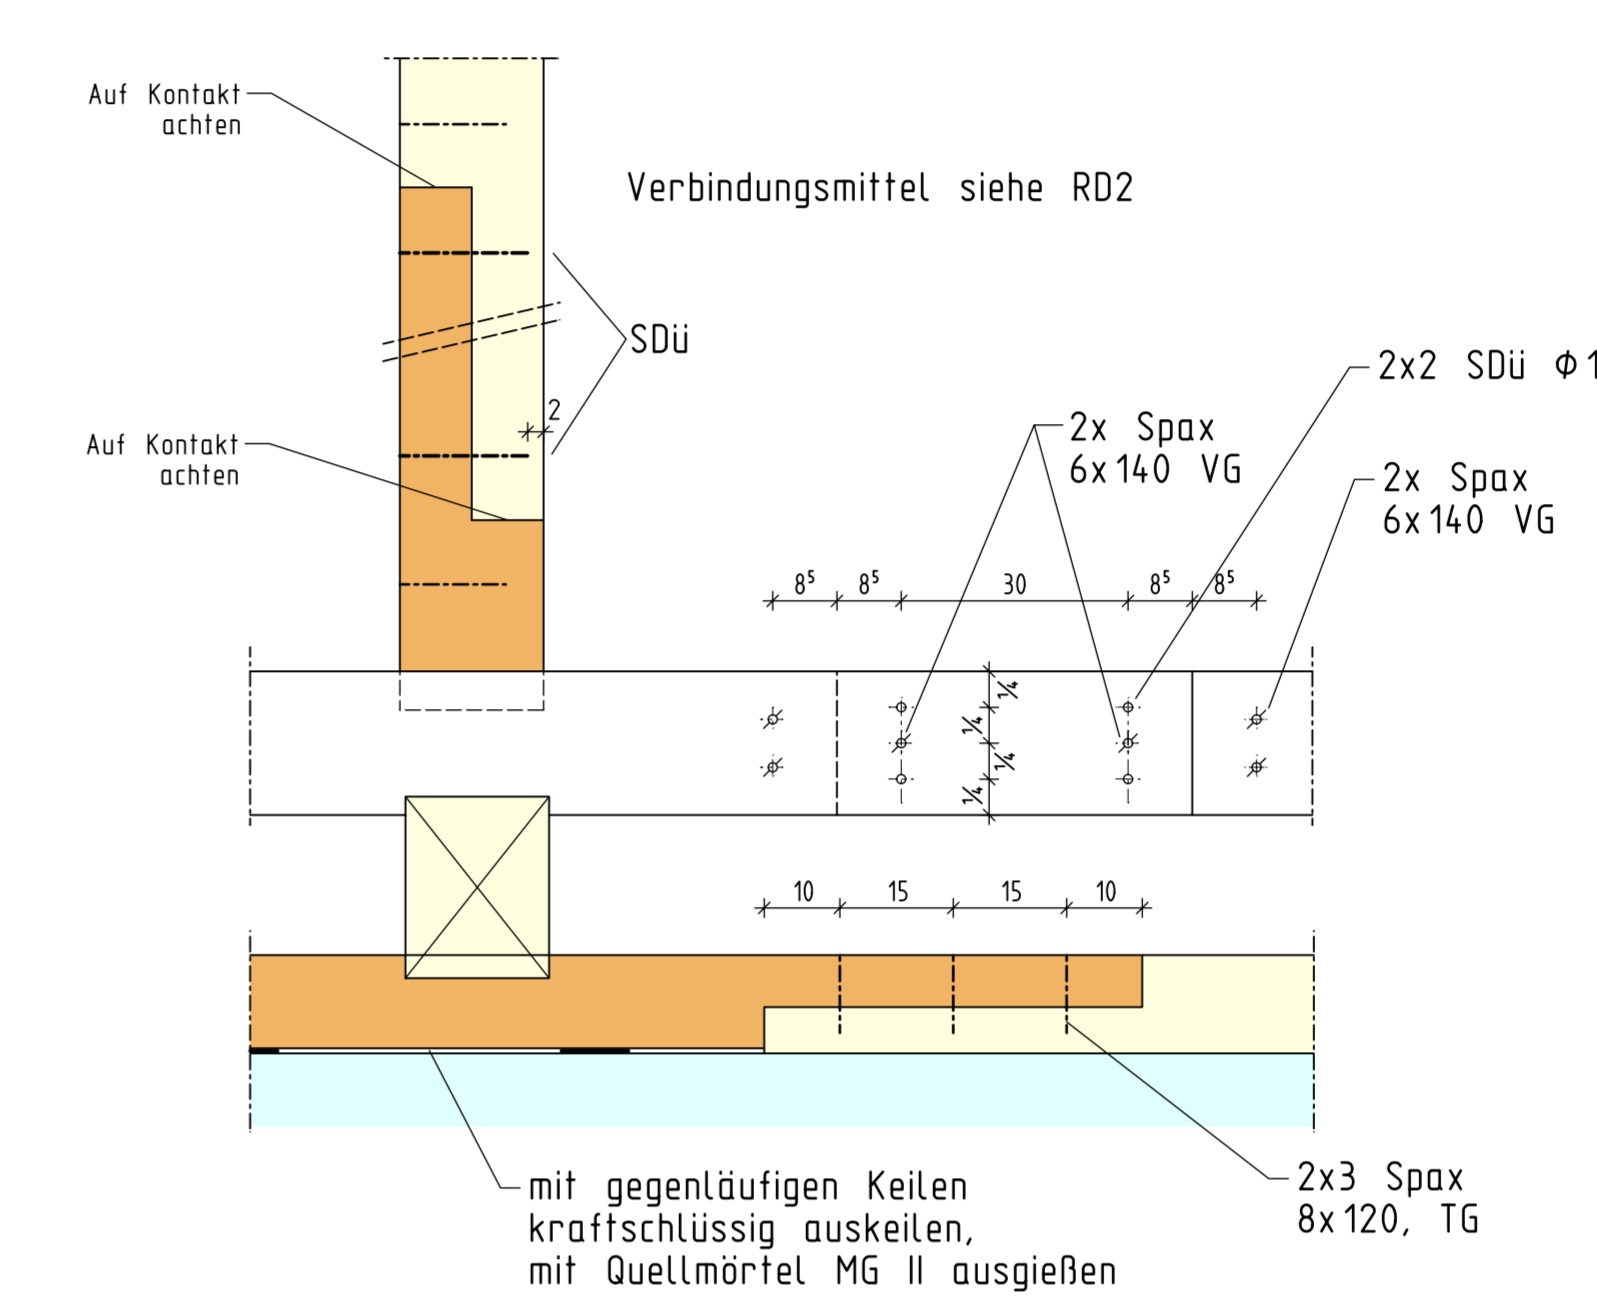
, M=1:10 Regeldetail Reparatur Deckenbalken
